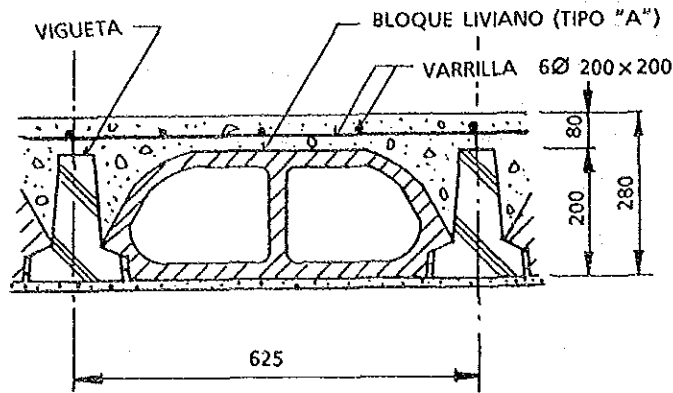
Estructura de la Losa de Vigueta Prefabricada
